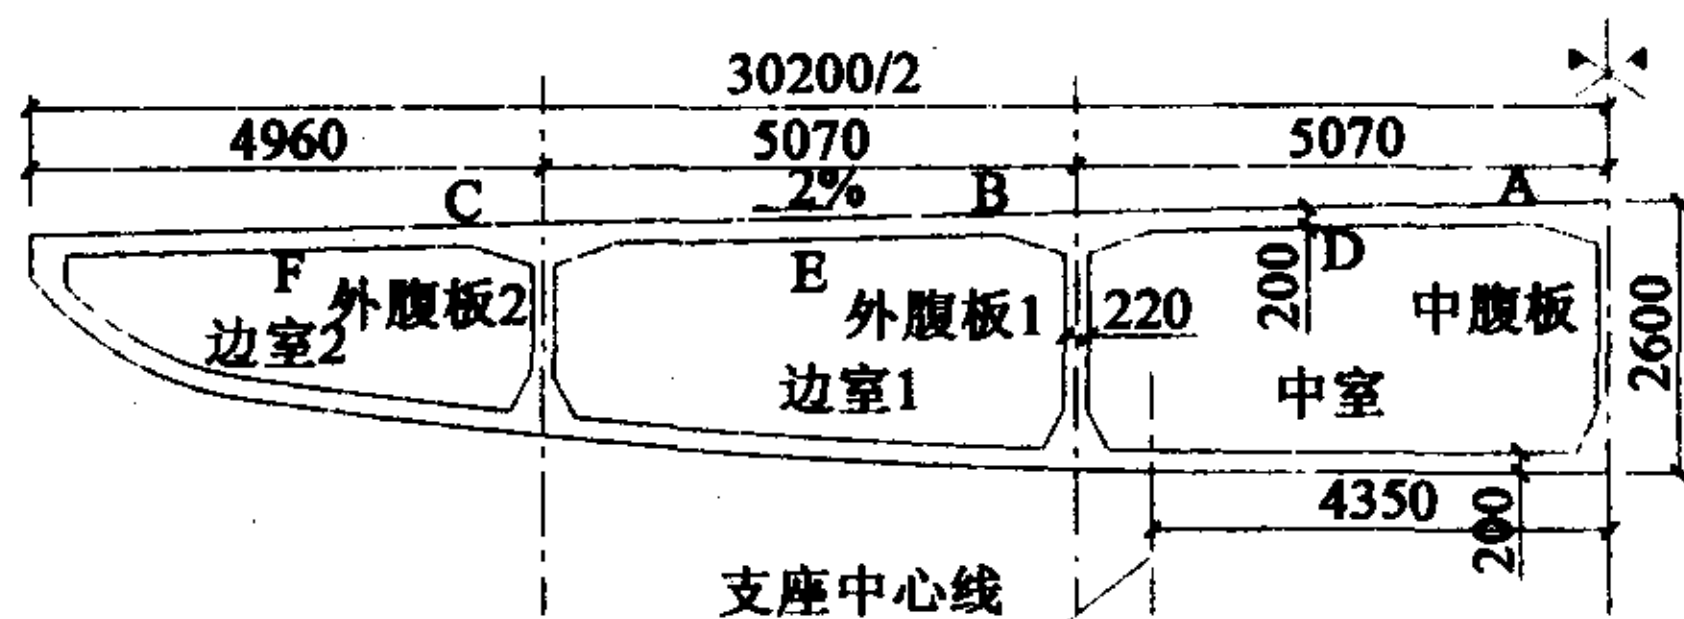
弧形底箱梁跨中截面示意图(单位: mm)
